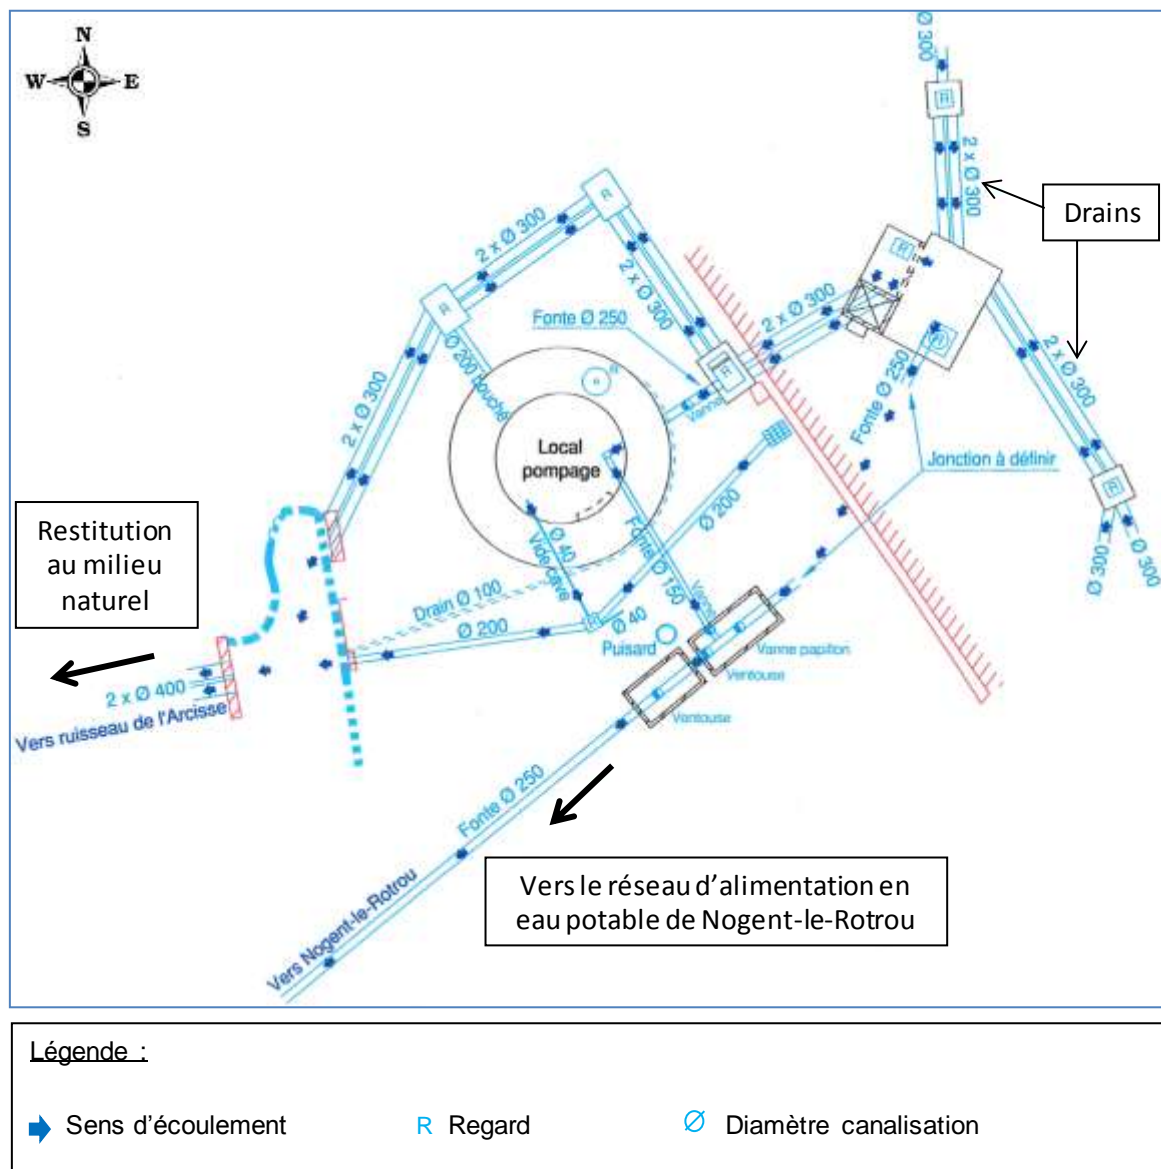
Plan des installations au droit du PPI du captage des Sources de l'Arcisses
